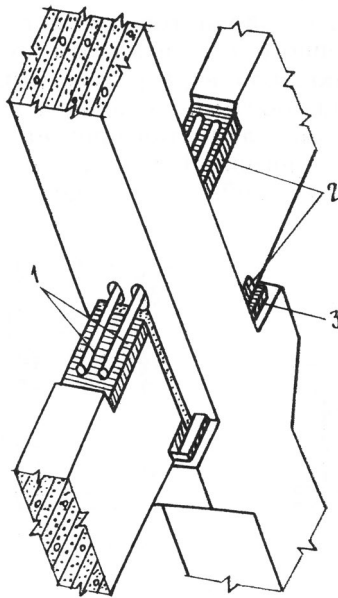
Стык неразрезного прогона с помощью арматурных стержней:
